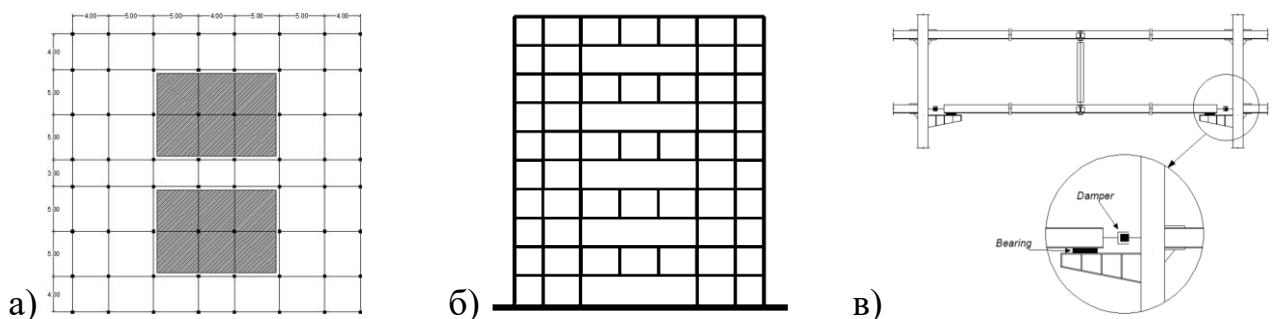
Здание с подвешенными внутренними частями перекрытий: а) план типового этажа; б) поперечный разрез несущей рамы; в; схема расположения демпфирующих устройств
